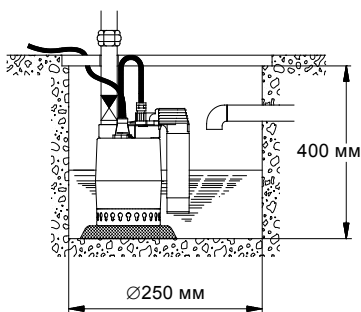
Мин. размеры резервуара для Unilift KP-AV
